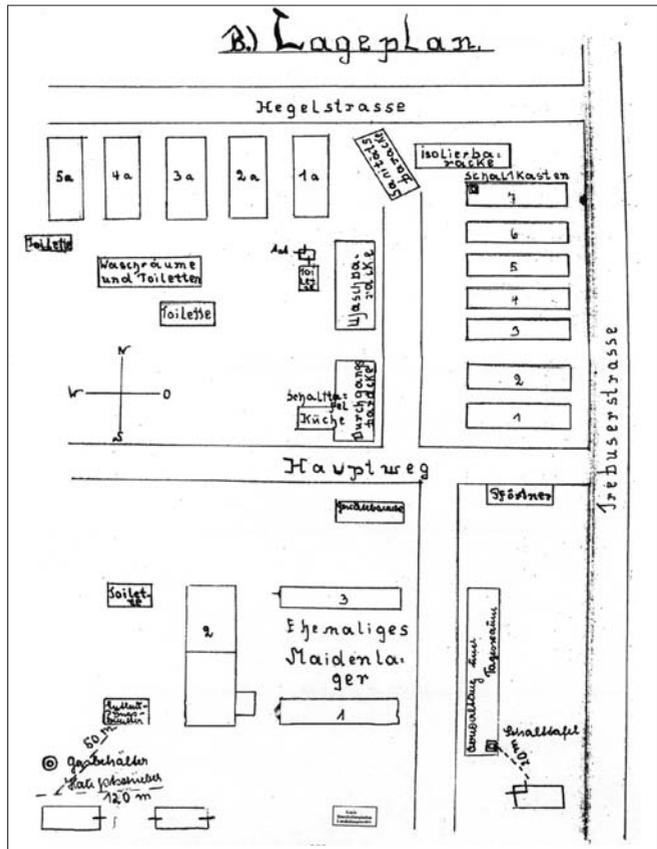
Lageplan des Vertriebenenlagers Fürstenwalde
